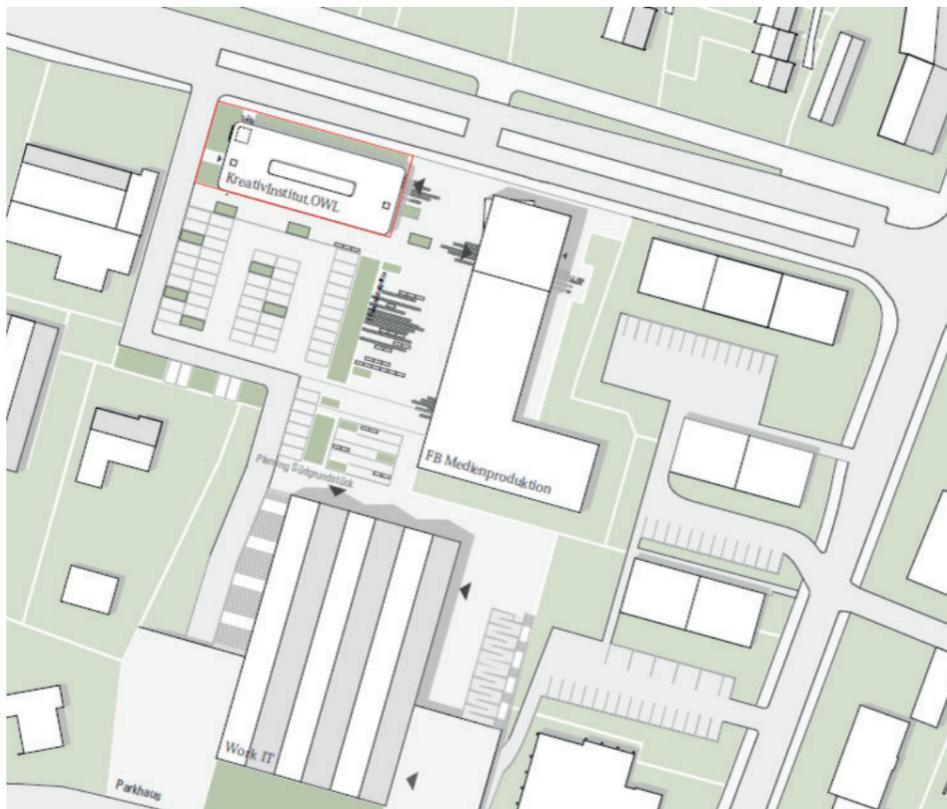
Lageplan Neubau am Campus Detmold, ohne Maßstab (OstWestfalenLippe GmbH o.J. a)
